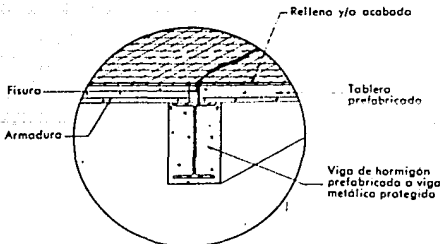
a) Fisuras debidas a cambios bruscos de sección.
